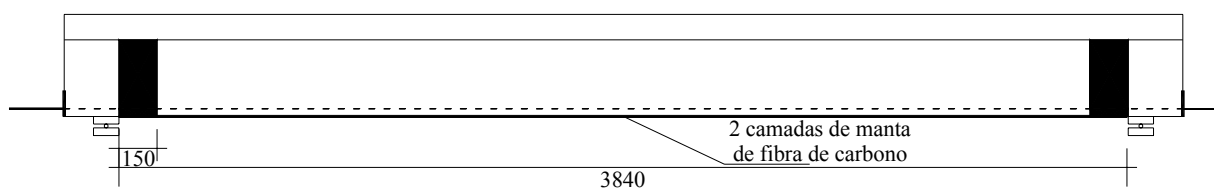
Detalhamento longitudinal do reforço colado externamente
